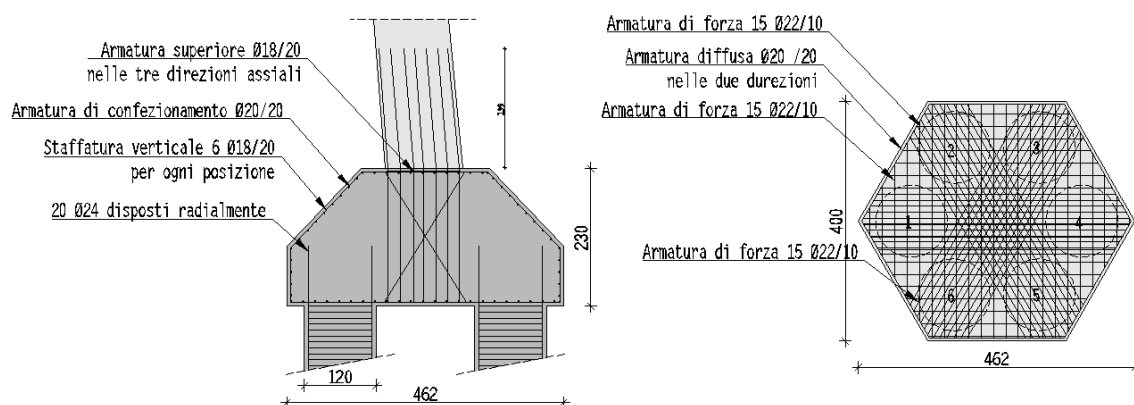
Plinto di fondazione antenna (quote in cm)
